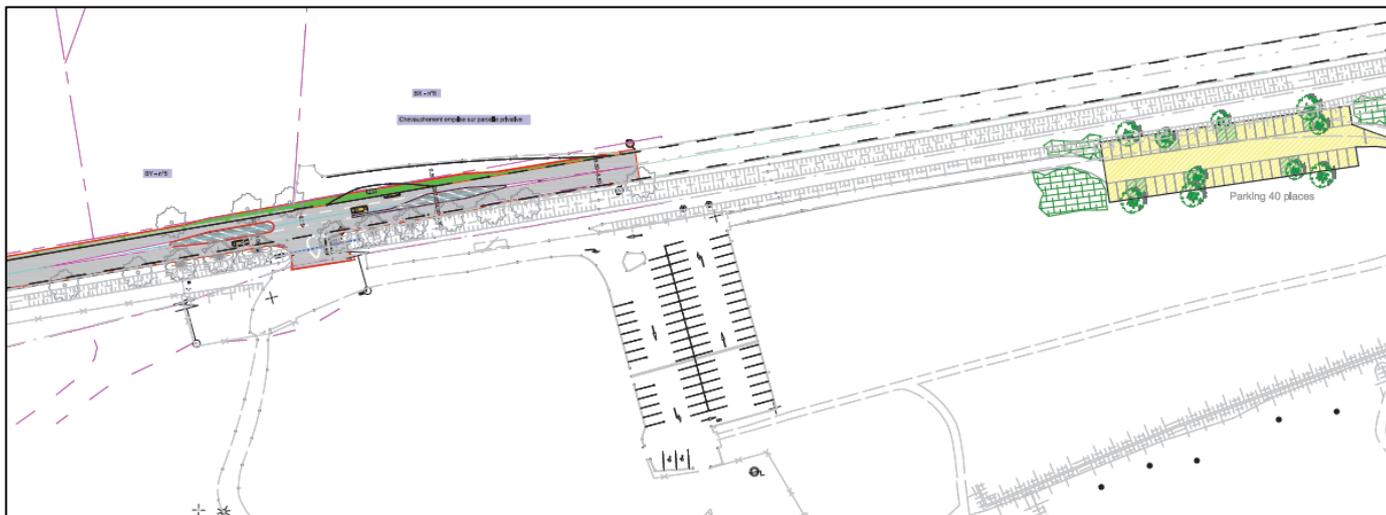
Plan de l'accès routier et de la zone de stationnement du projet
